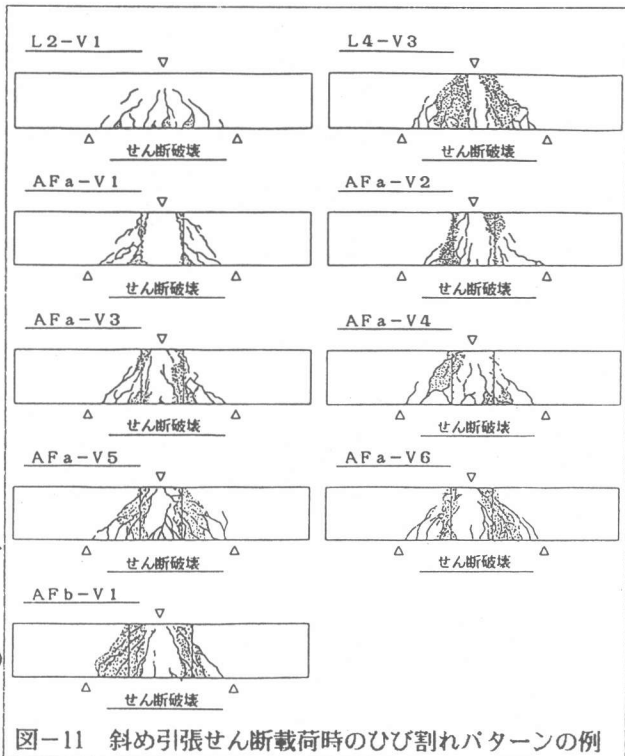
斜め引張せん断載荷時のひび割れパターンの例
